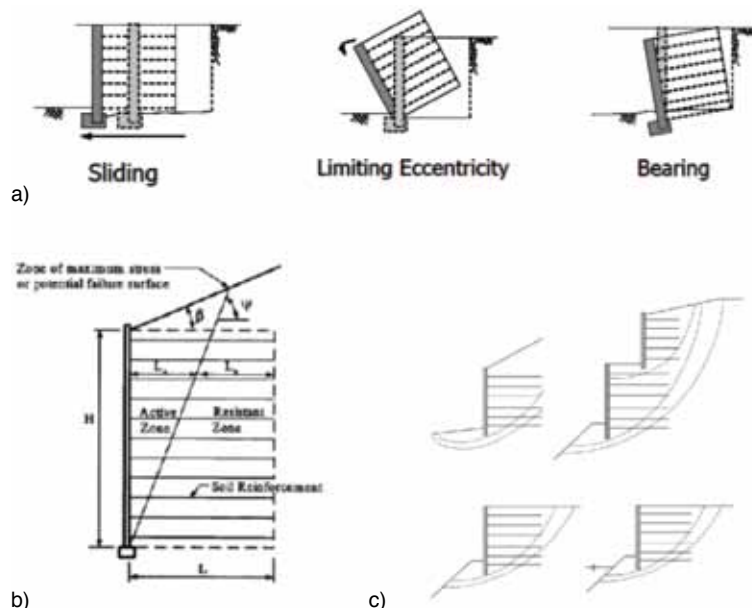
Meccanismi di rottura: a) Stabilità esterna, b) Stabilità interna, c) Stabilità globale
